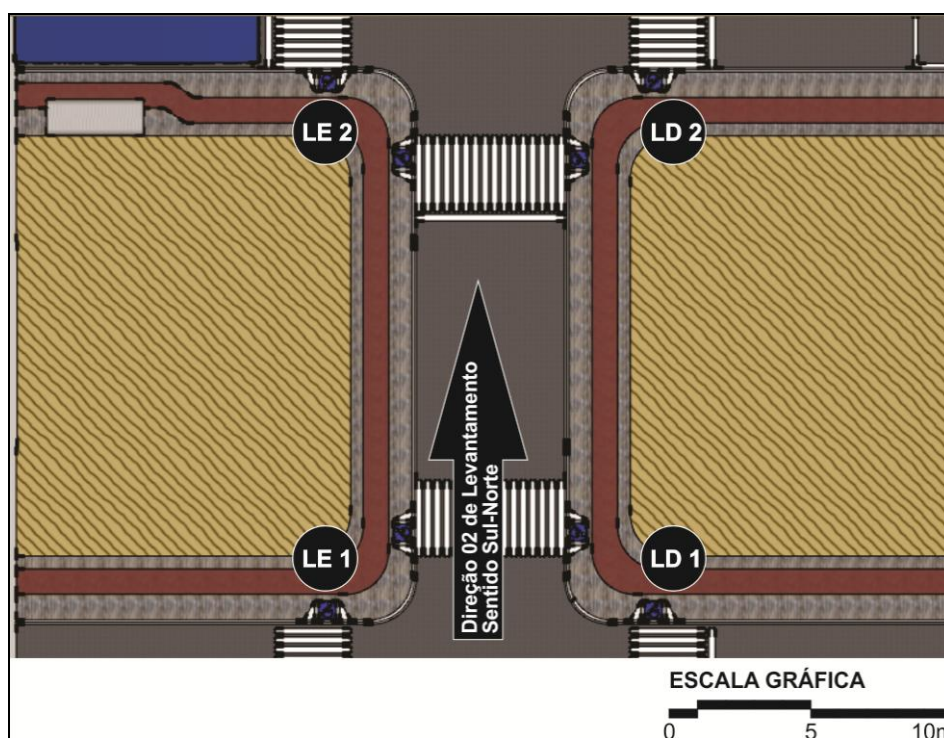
Esquema de orientação para o levantamento das rampas de rebaixamento de guia.
